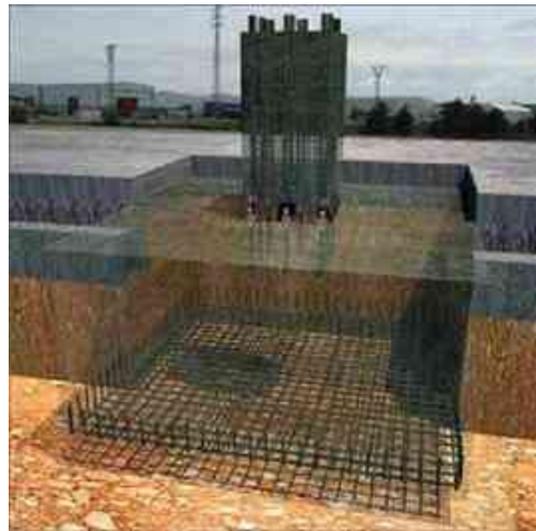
" Zapata aislada". Imagen a manera de ejemplo. Fuente internet
